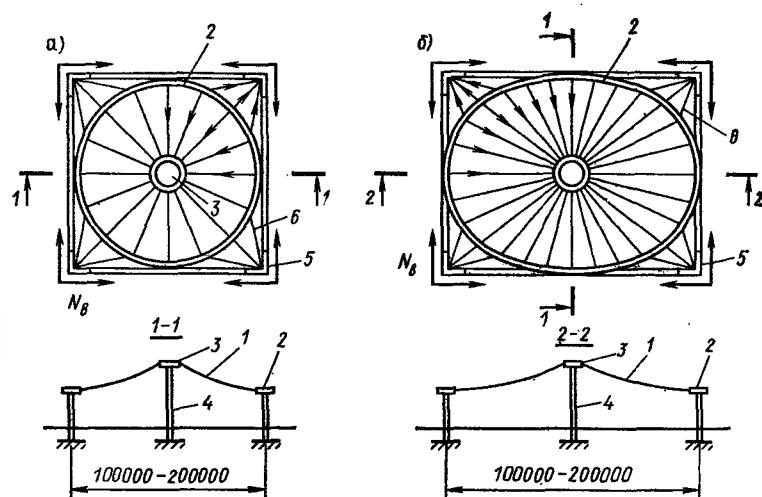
Схемы однопоясных радиальных покрытий для зданий
